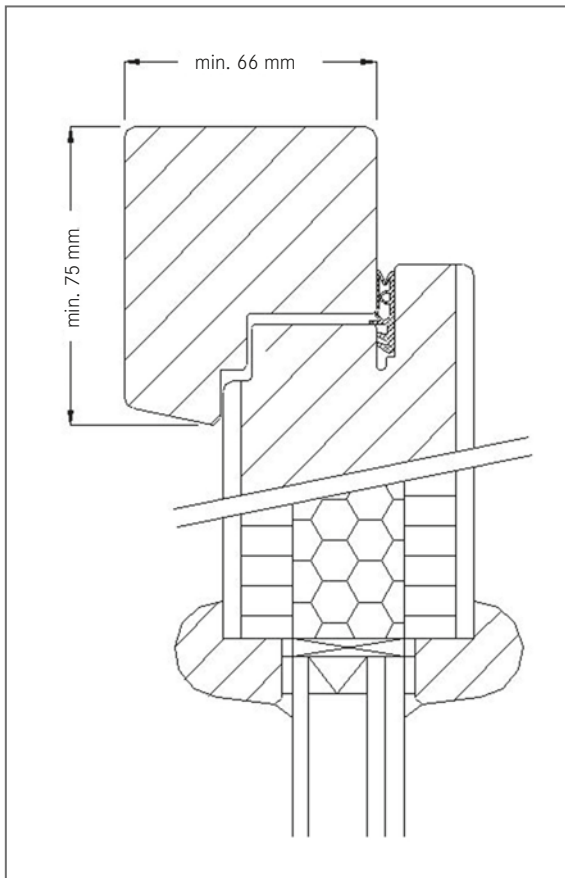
Doppelfalz mit Einfachdichtung [Quelle: TSH System GmbH]
